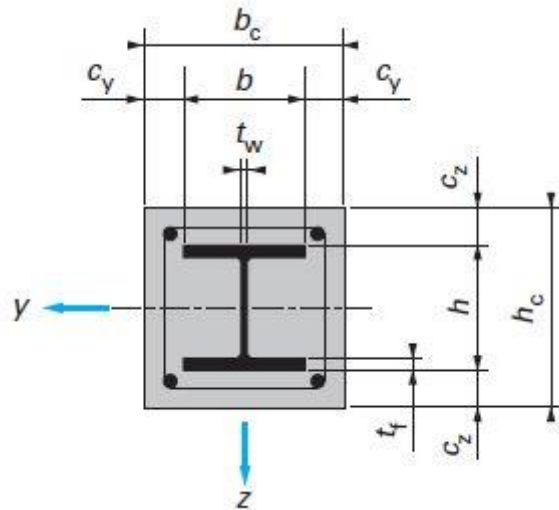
Section rectangulaire du poteau mixte totalement enrobé.
